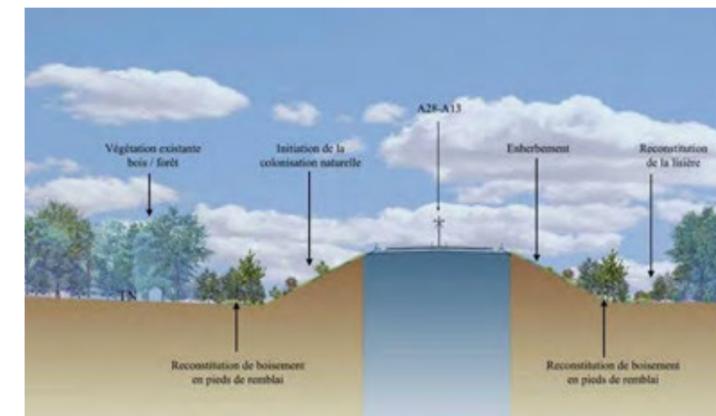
COUPE TYPE SUR REMBLAI EN ZONES BOISEES
